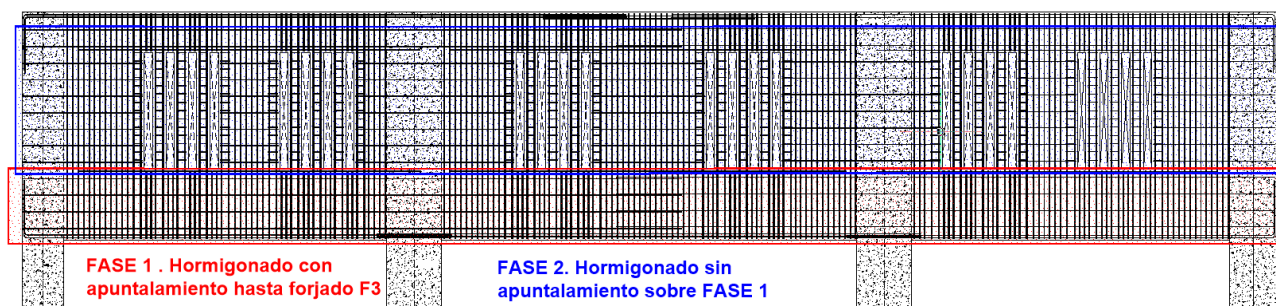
Fases hormigonado viga puente entre forjados F6 y F7
